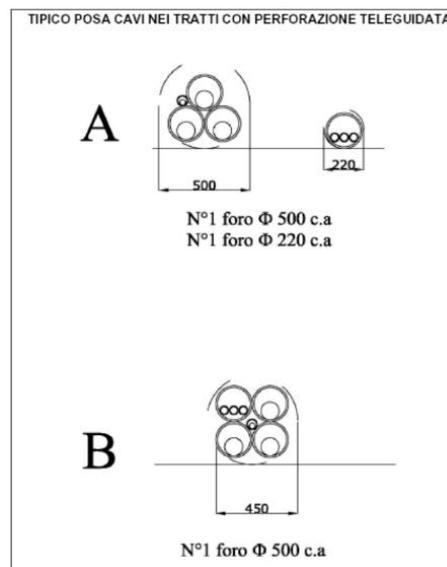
Sezione Tipo Attraversamento con foro pilota
